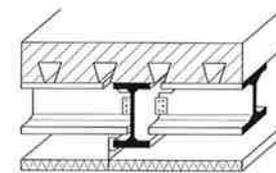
Faux-plafonds suspendu servant de protection incendie pour les poutres
